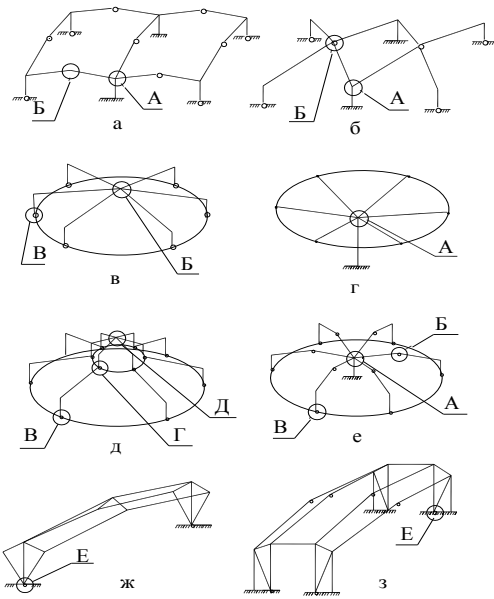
Конструктивні схеми каркасів споруд із залізобетонних рам: а – блок-модуль з чотирьох рам; б – блок-модуль з двох рам; в – схема каркасу круглого в плані; г – схема каркасу круглого в плані з єдиним стояком; д – схема каркасу круглого в плані типу башта; е – схема каркасу круглого в плані з центральним стояком; ж – схема каркасу з трьох рам; з – схема каркасу з чотирьох рам; А, Б, В, Г, Д, Е – вузли з'єднань елементів каркасу
